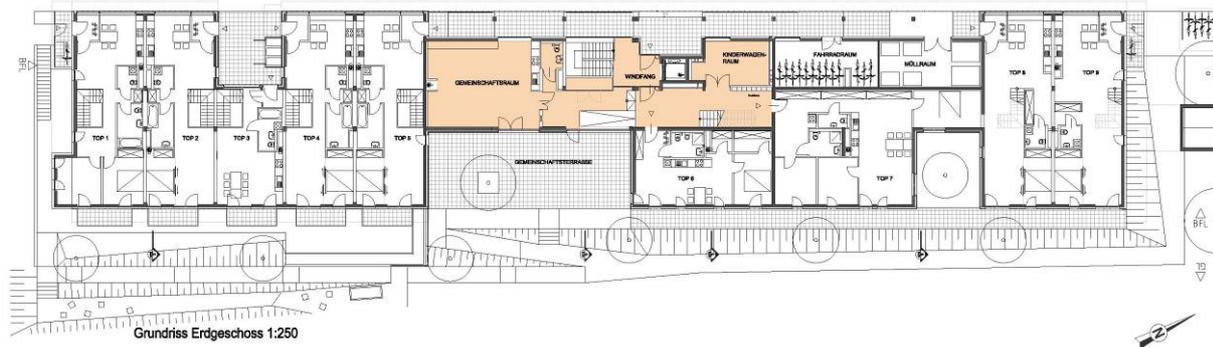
Frauenwohnprojekt [ro\*sa] Donaustadt, Erdgeschoß- und Lageplan; maßstabslos.
